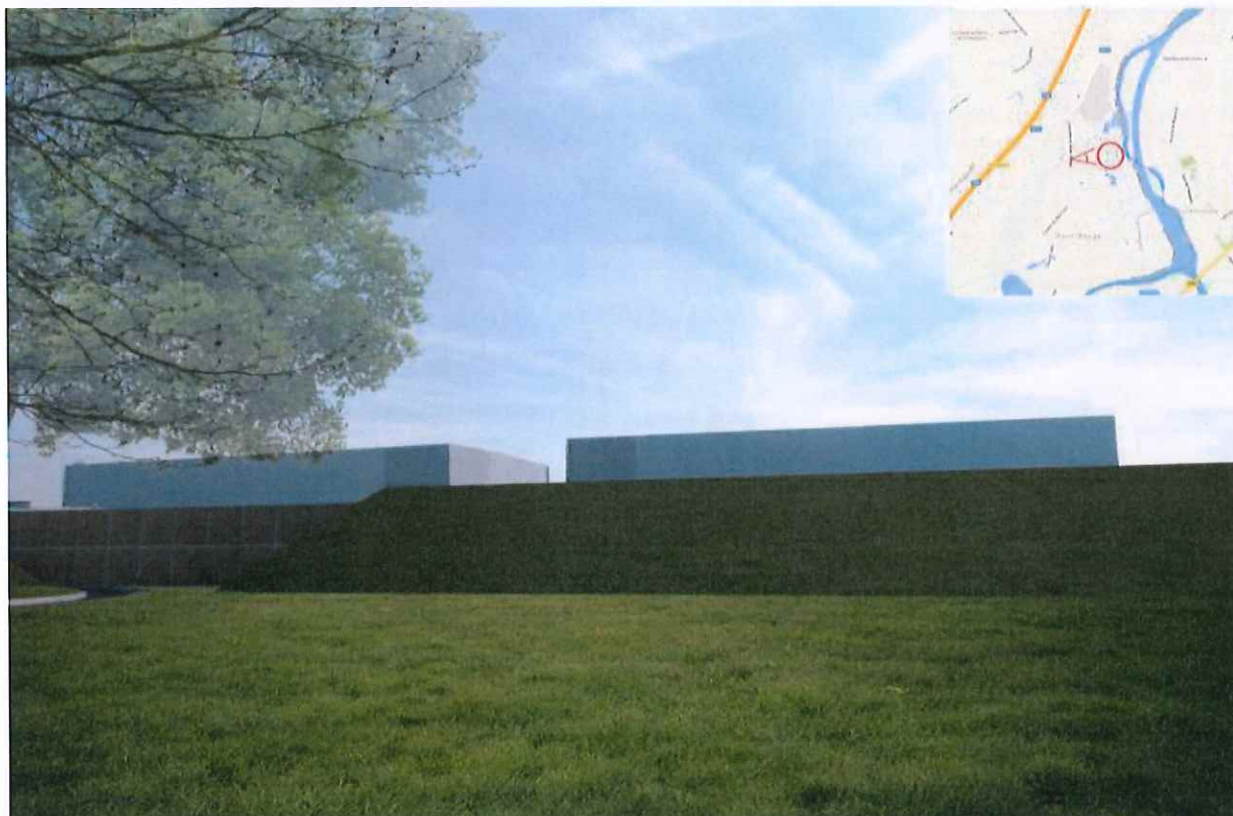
PM 9 – Coupe et vue depuis le nord de la chaussée du Pont Rouge (source : CL WARNETON, 2016)
